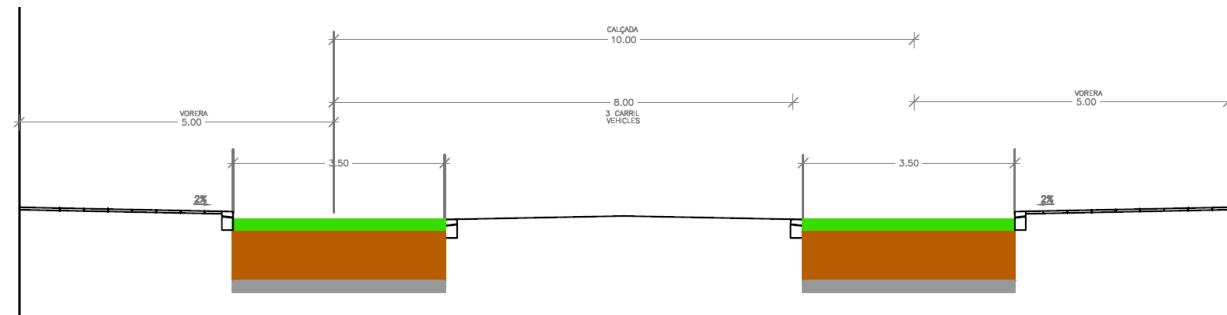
Sección transversal de la propuesta para la C/ Lepanto, caso c) (Tipo 2).
